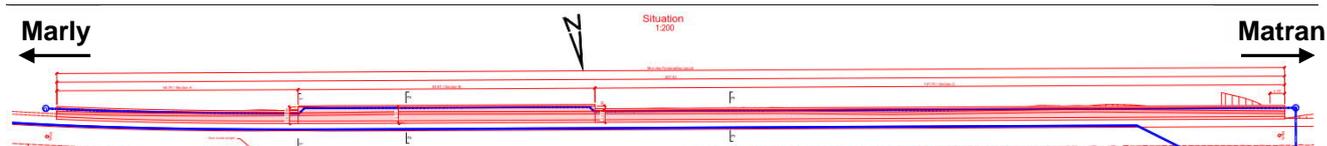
Extrait de situation du Mur des Fontanettes amont
